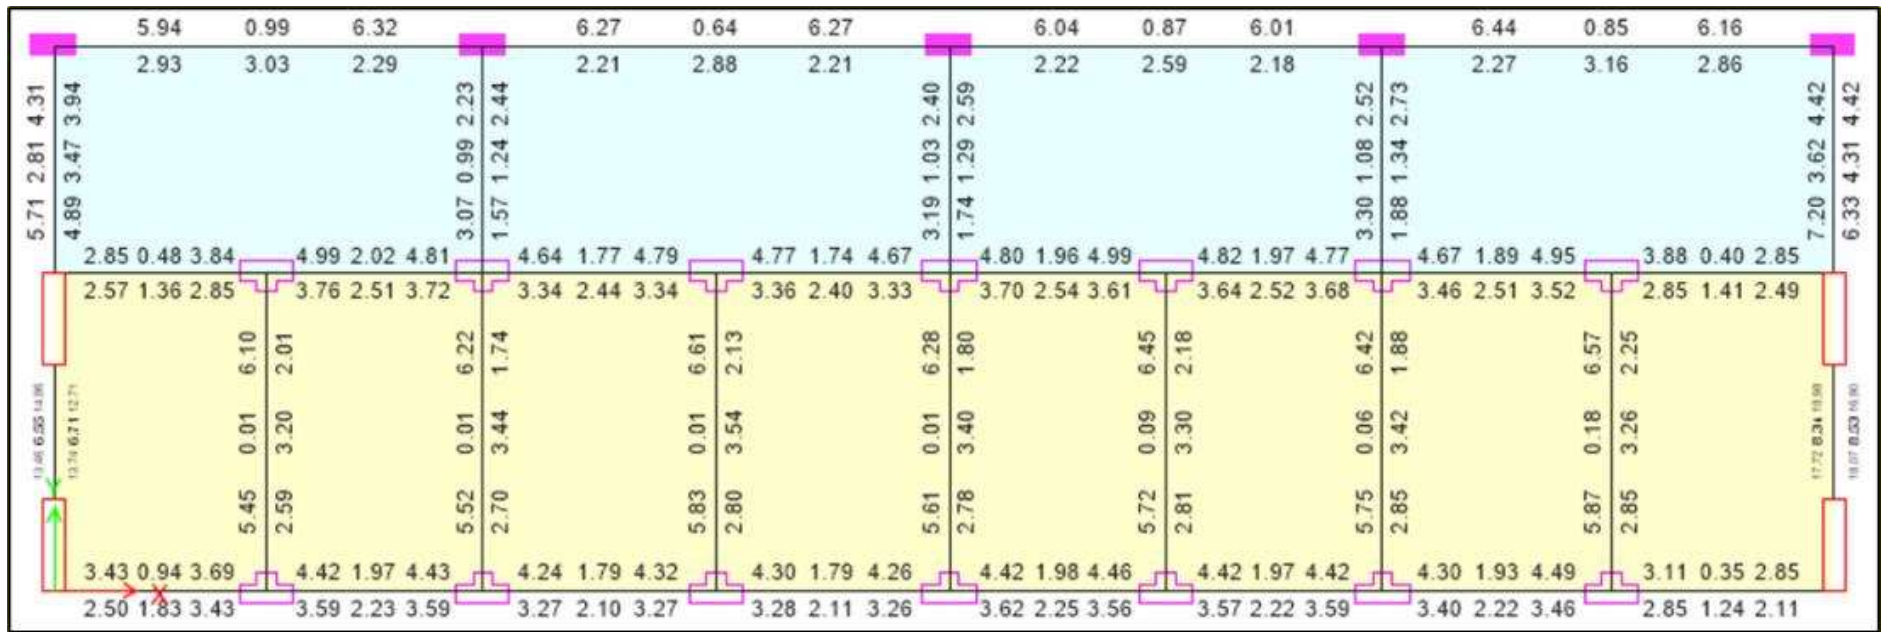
Cuantías calculadas en vigas del primer techo, Modulo B=D
